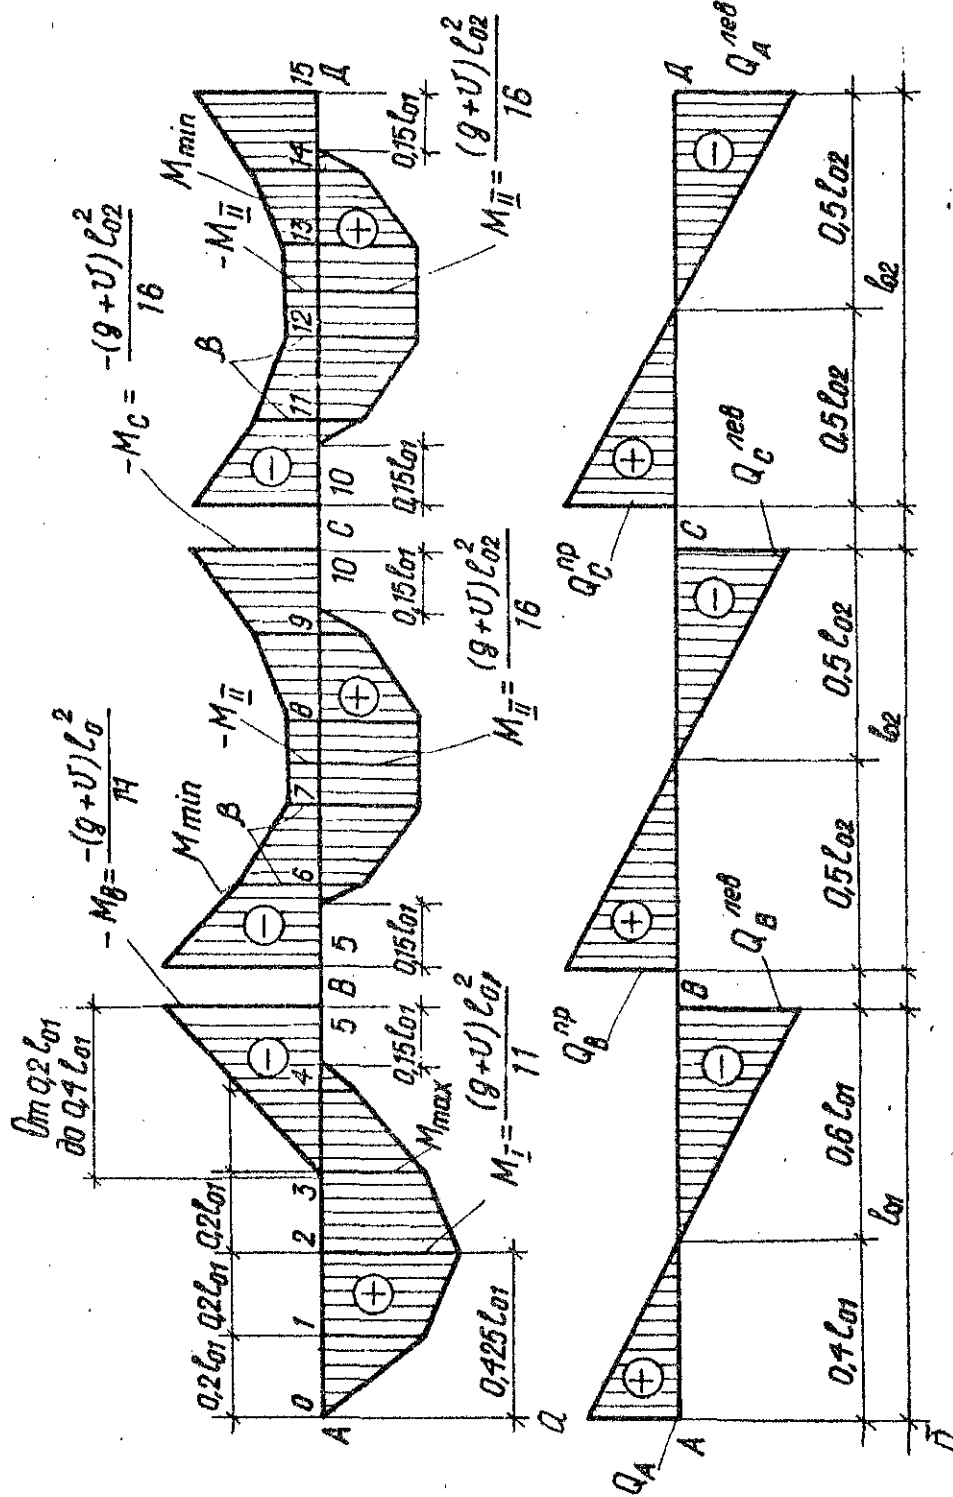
Эпюры усилий: а - огибающая эпюры моментов M ; б - эпюра перерезывающих сил
